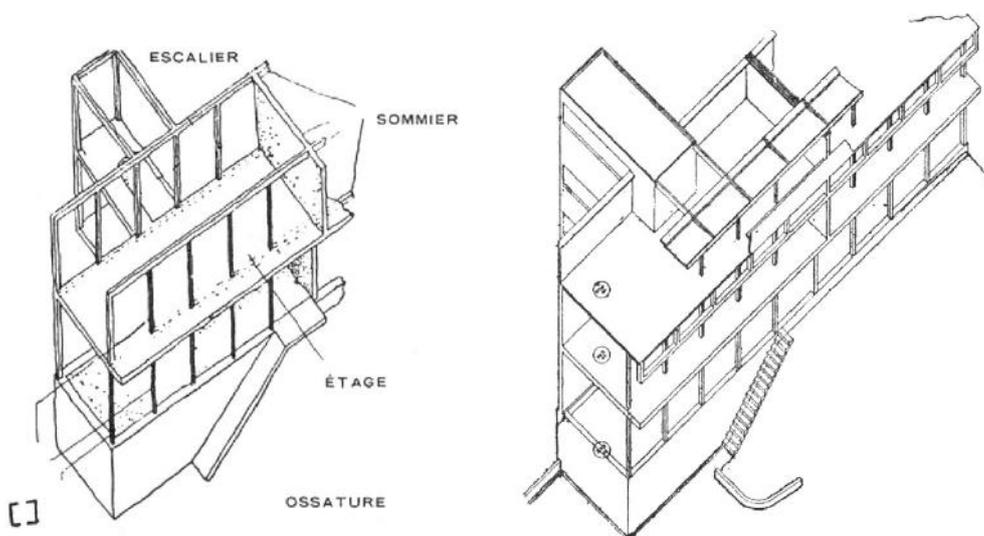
Axonometrías de la estructura de la vivienda pareada.
